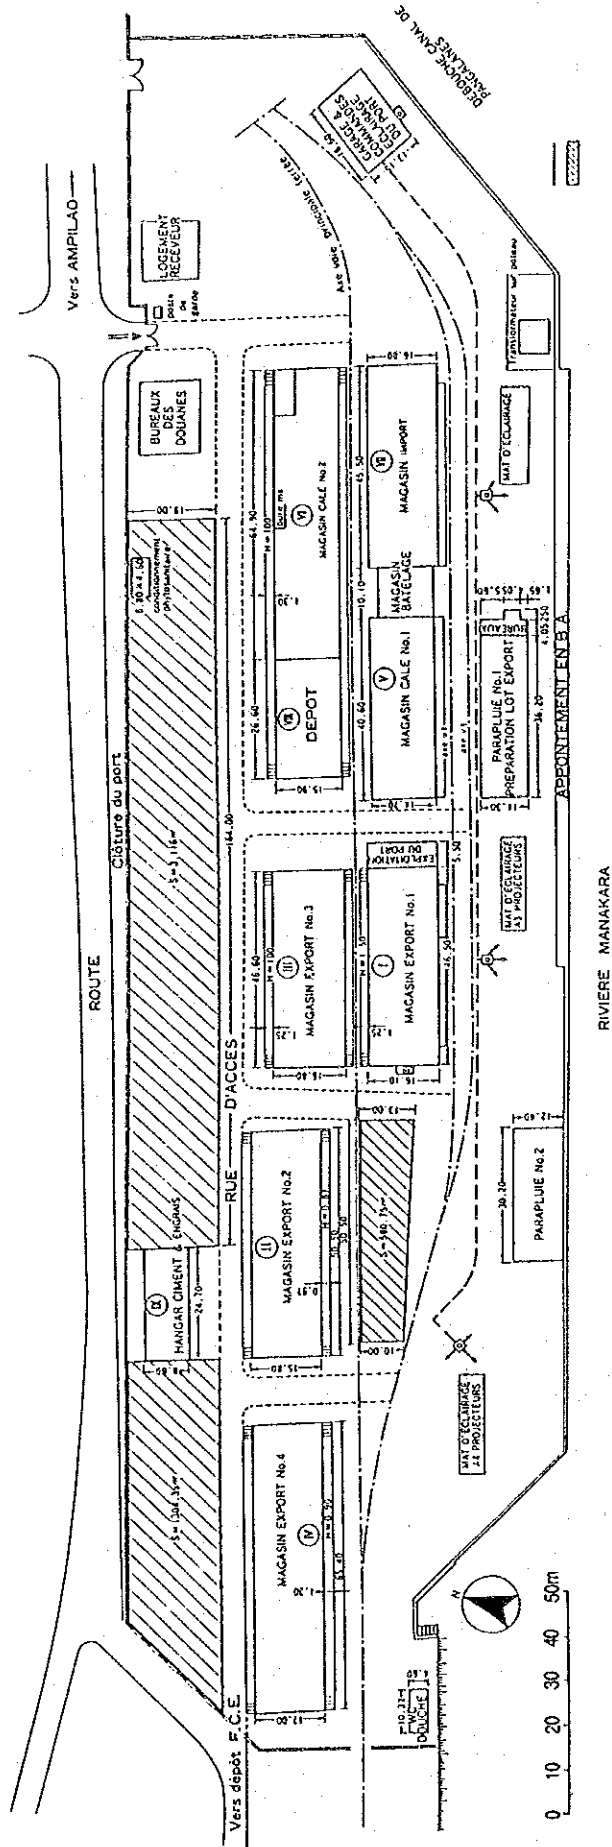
Plan d'implantation du Port de MANAKARA
